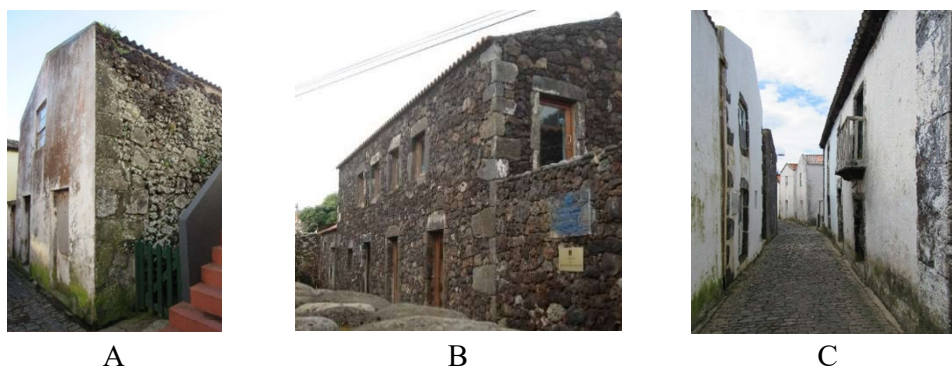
Ilustração do tipo de materialidade aparente das fachadas
